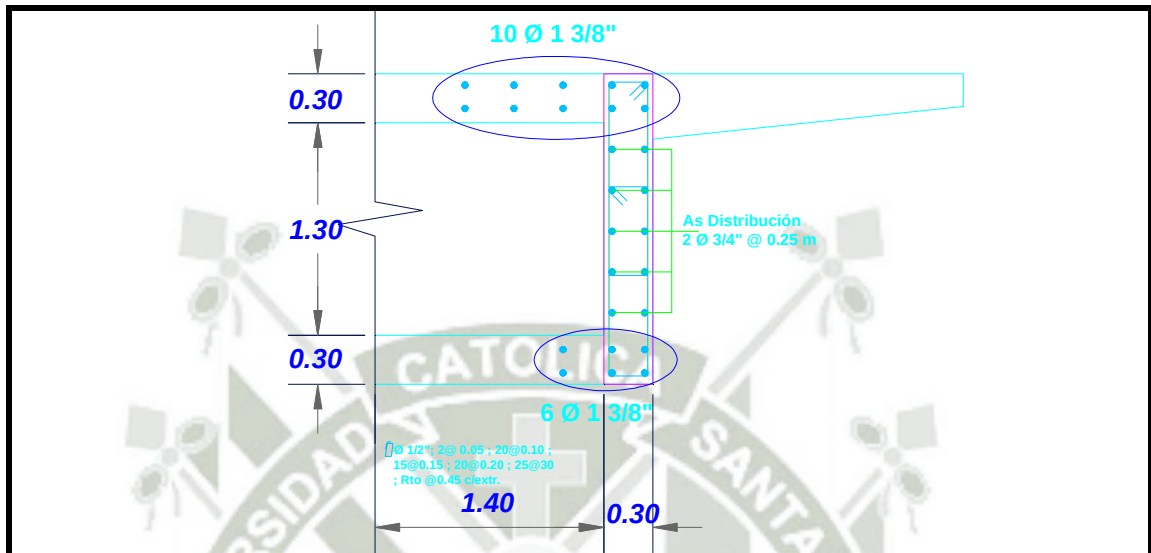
Diseño en Concreto Armado – Viga Exterior del Tablero de Puente
